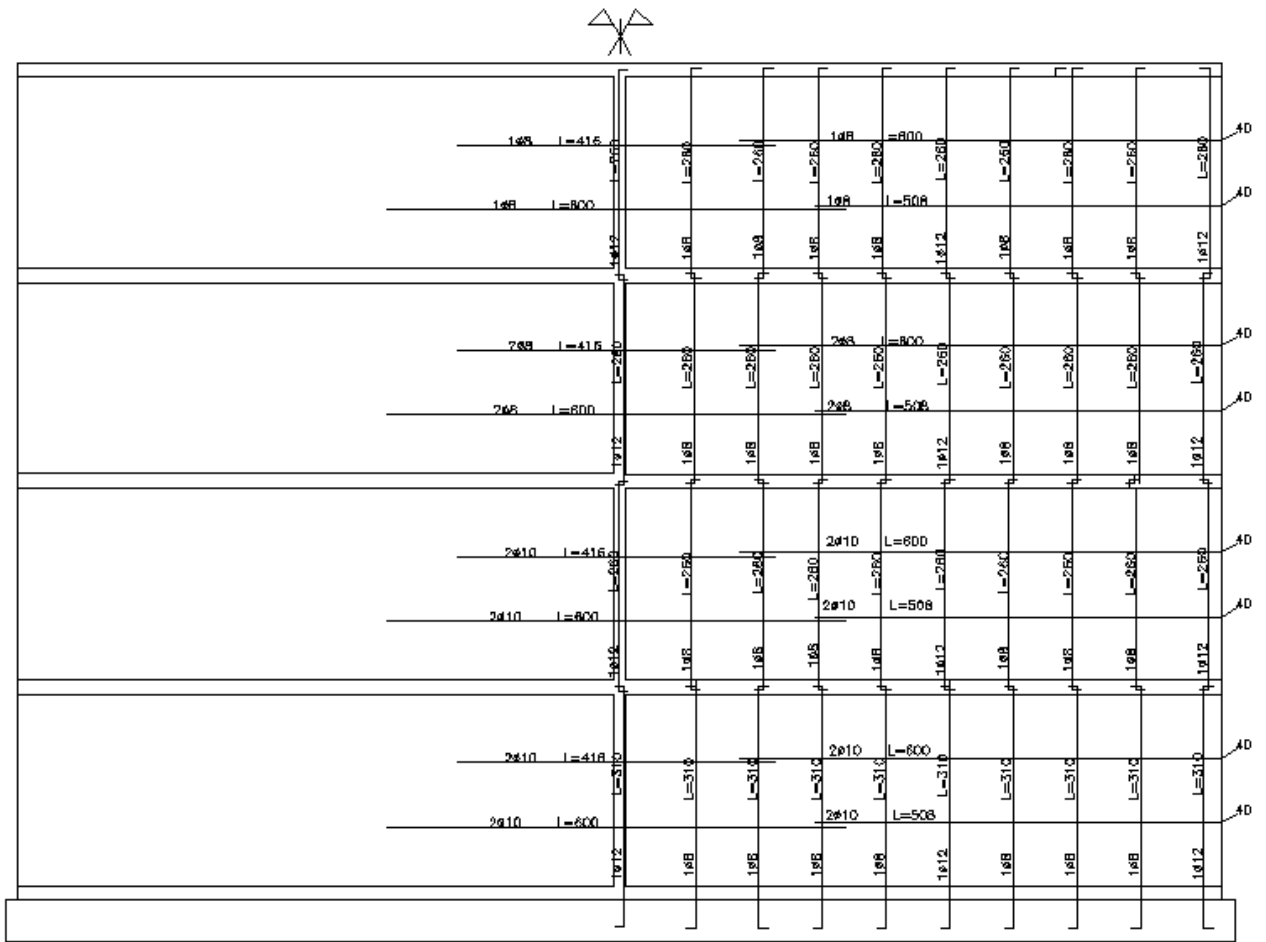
3. Armadura de refuerzo muro medianero Eje 2 y B. Edificio de 4 pisos del Tipo A
